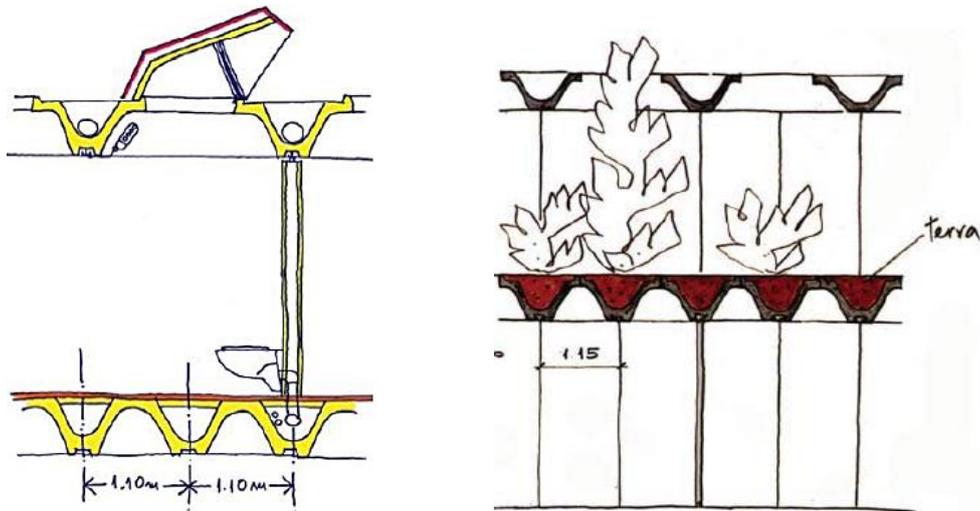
Cortes esquemáticos de las vigas canal y sheds premoldados en cubierta
